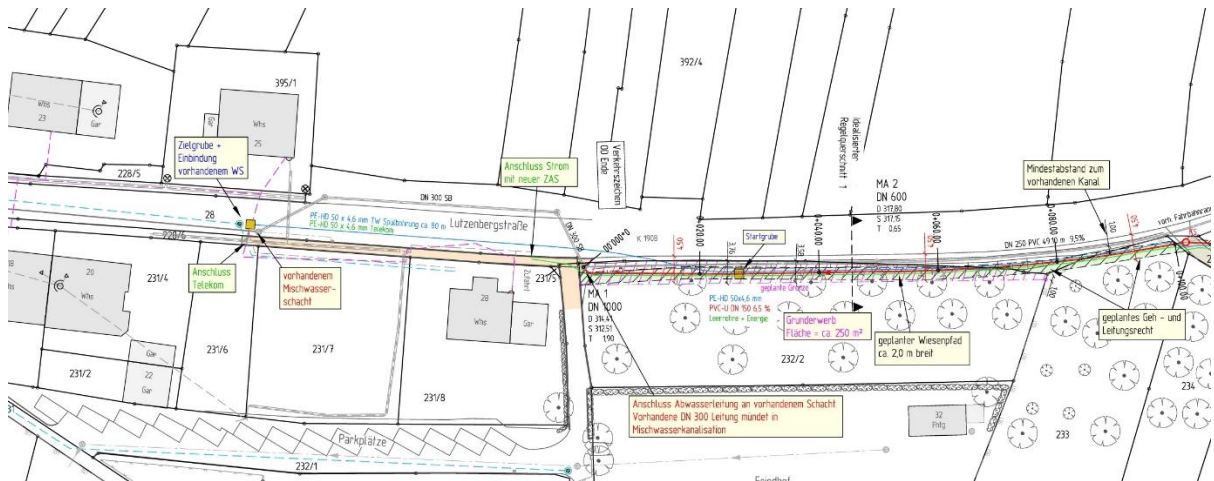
Westlicher Ausschnitt aus dem Erschließungsplan des Büros Riker + Rebmann
